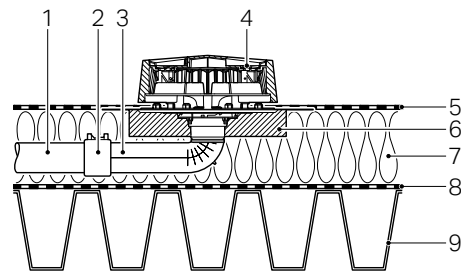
Aufbau Leichtdach gedämmt, horizontaler Abgang in Wärmedämmung, mit Dachabdichtungsfolie und Dampfsperre
